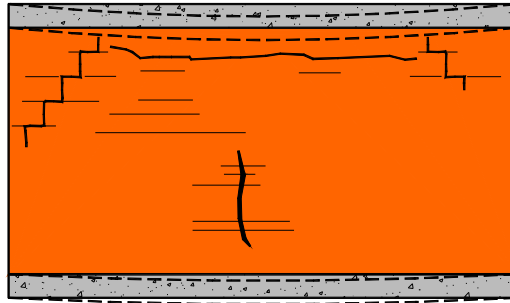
Fissuras em parede de vedação: deformação do suporte inferior à deformação da viga superior [30]
